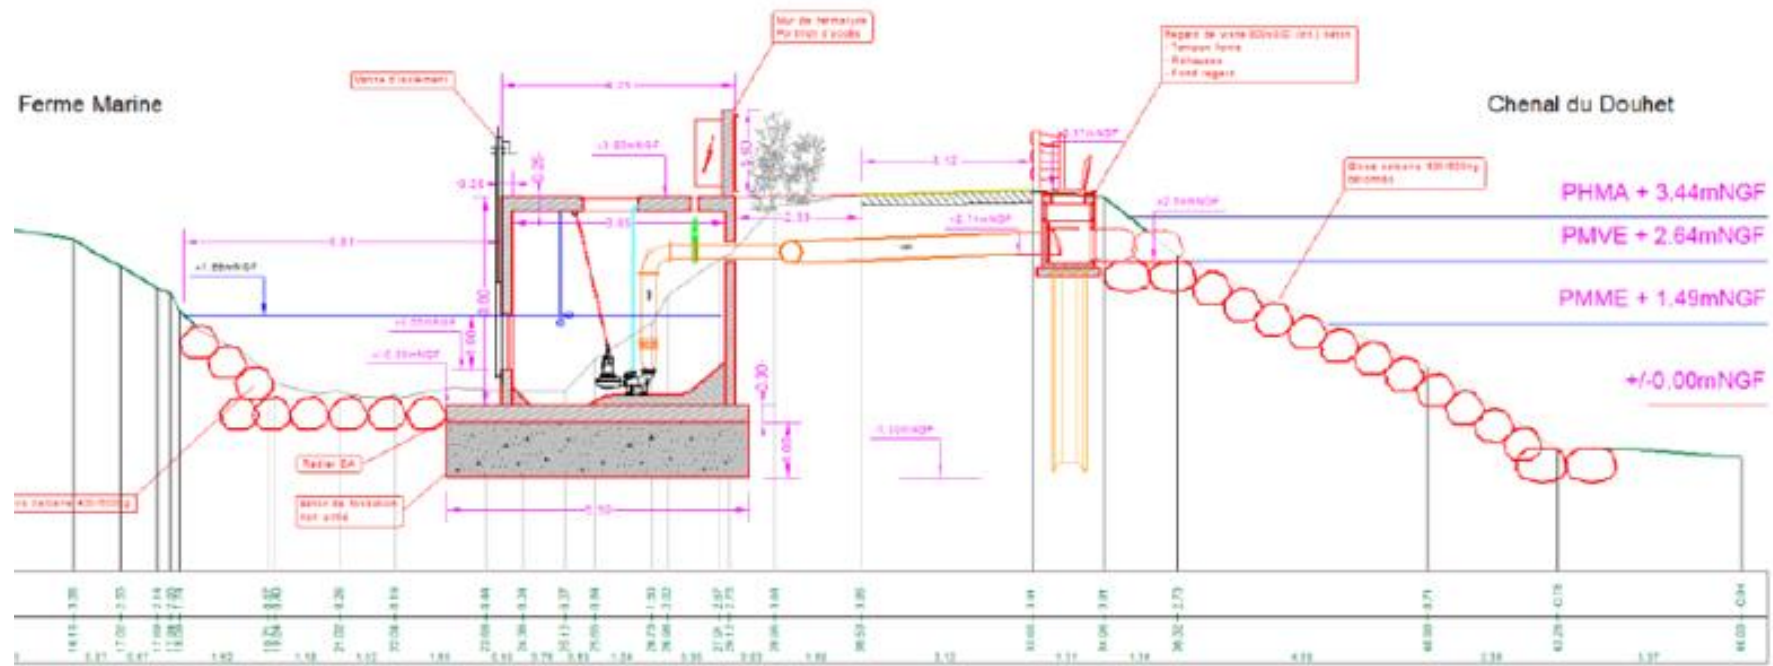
Plan en coupe de la station de pompage – Présentation AVP
